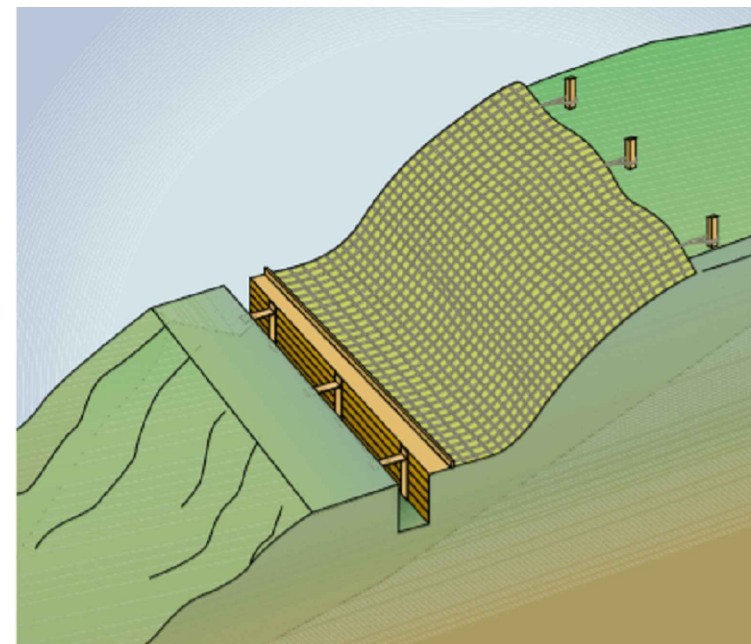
Escavação mista – com paredes em taludes e com paredes protegidas por cortinas
